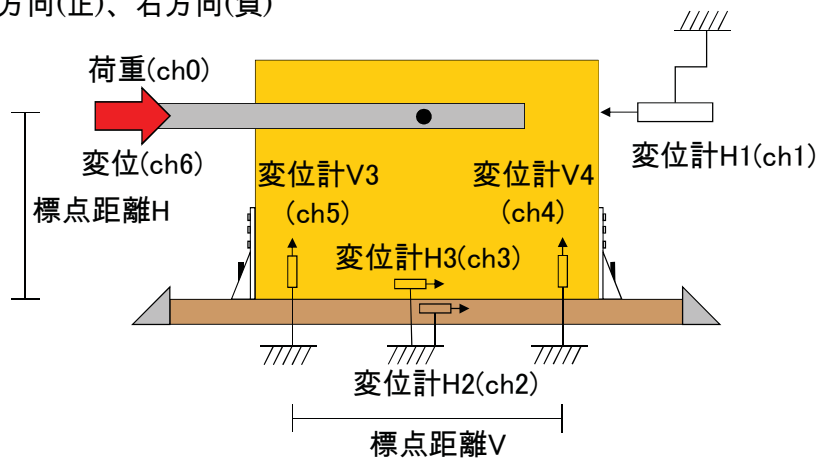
CLT 試験体の設置方法と計測箇所 (NB1-3、L1-3)
